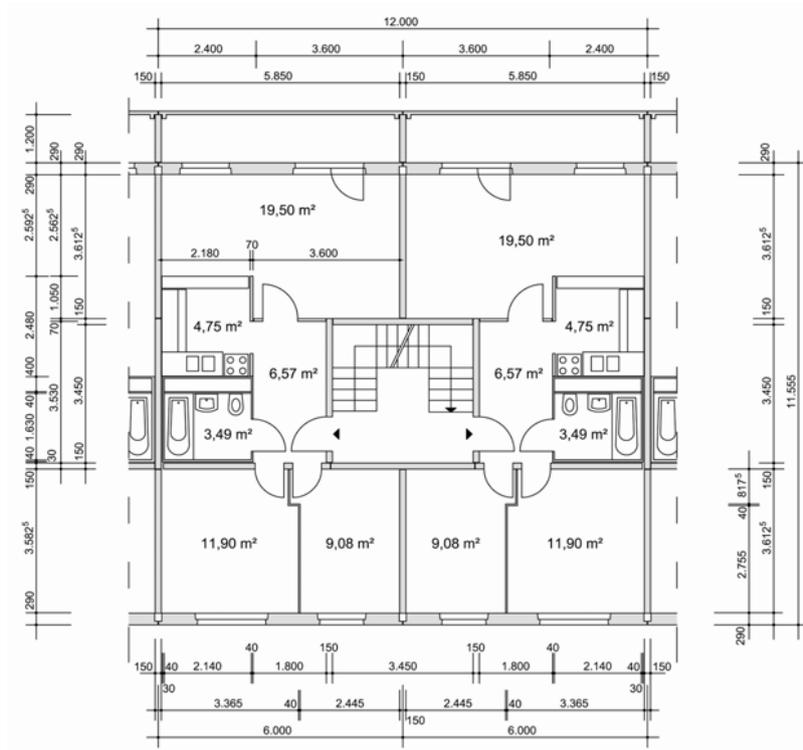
Grundriss Normalgeschoss – Segment der Plattenbauserie P2¹⁹
